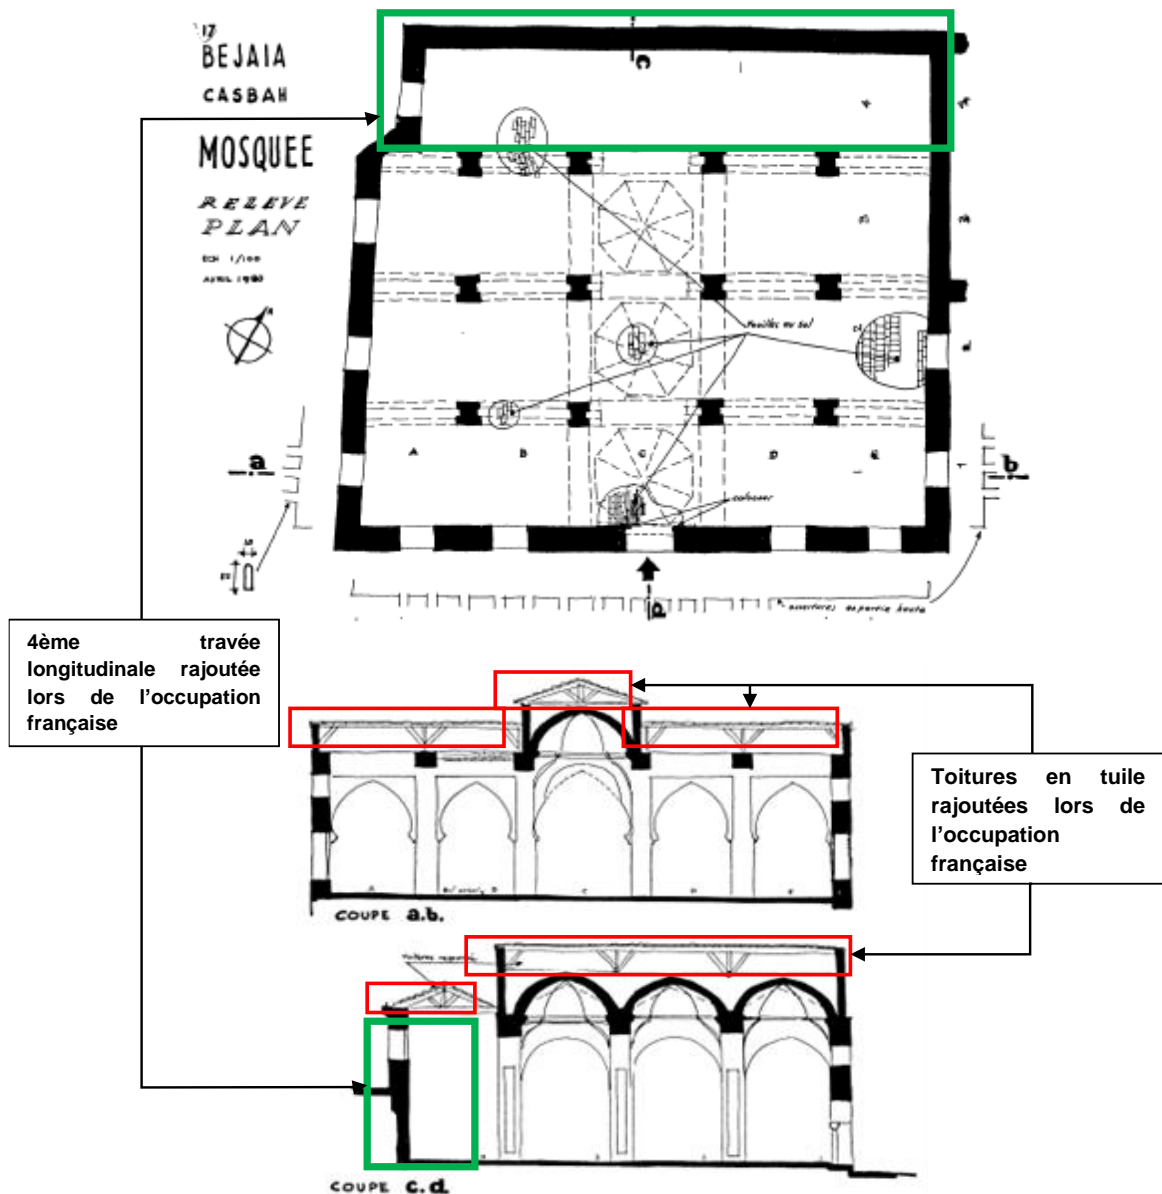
Coupes et plan de la mosquée de la Casbah de Bejaia
